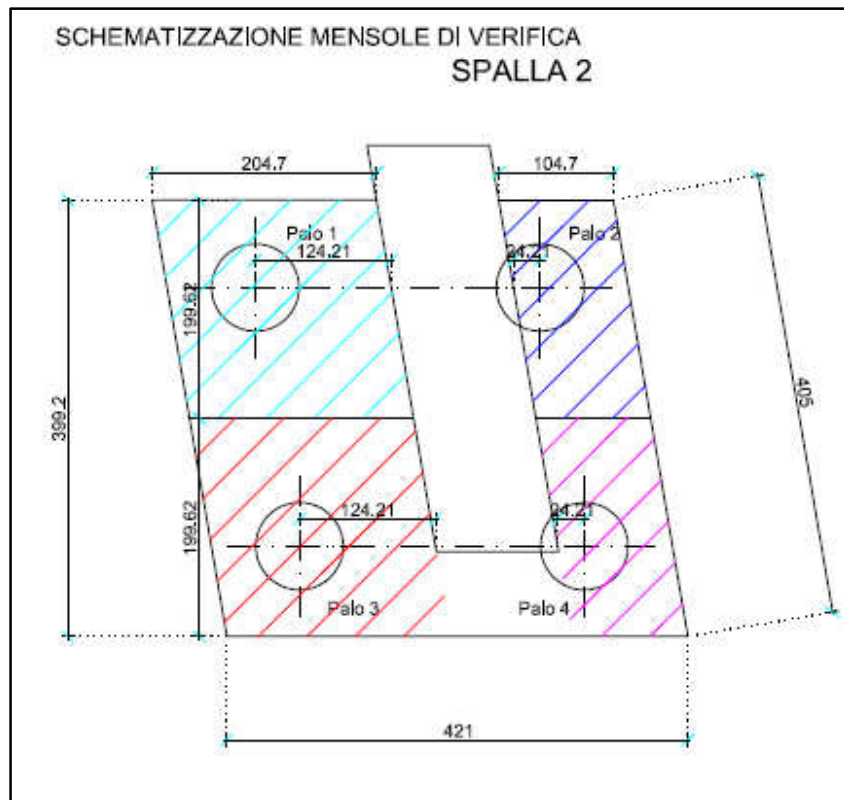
Platea e palificata di fondazione della piedritto/spalla 2 – schematizzazione mensole per calcolo sollecitazioni di verifica platea
